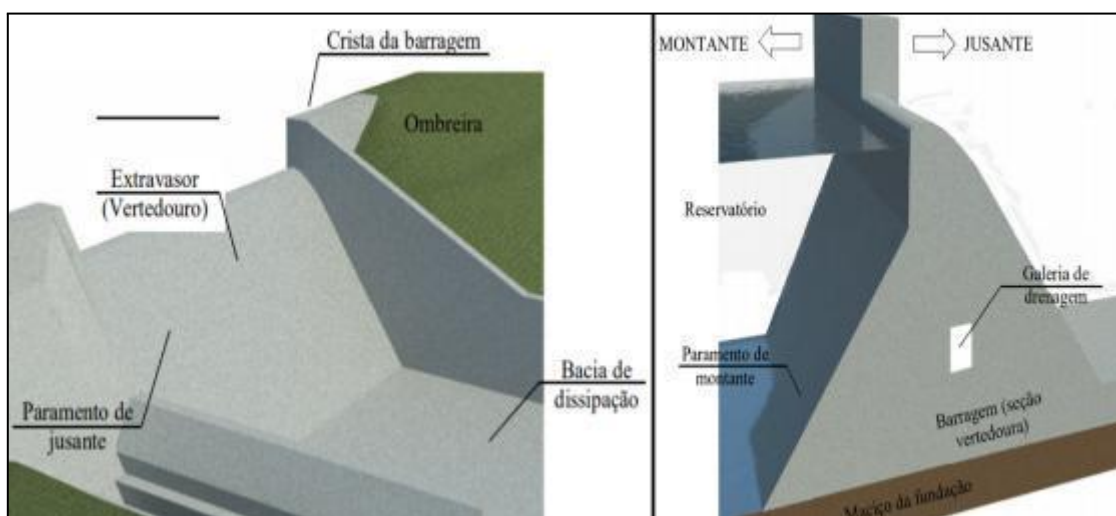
Componentes de uma barragem de concreto (Adaptado de MOURA (2016)).
